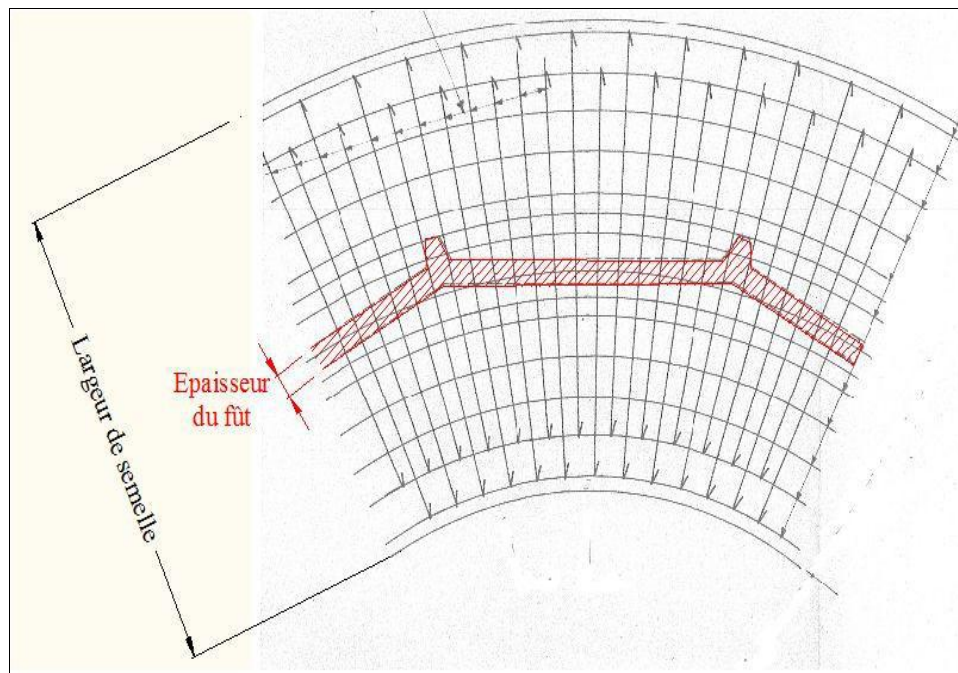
Vue en plan du ferrailage d'une semelle de fondation circulaire
